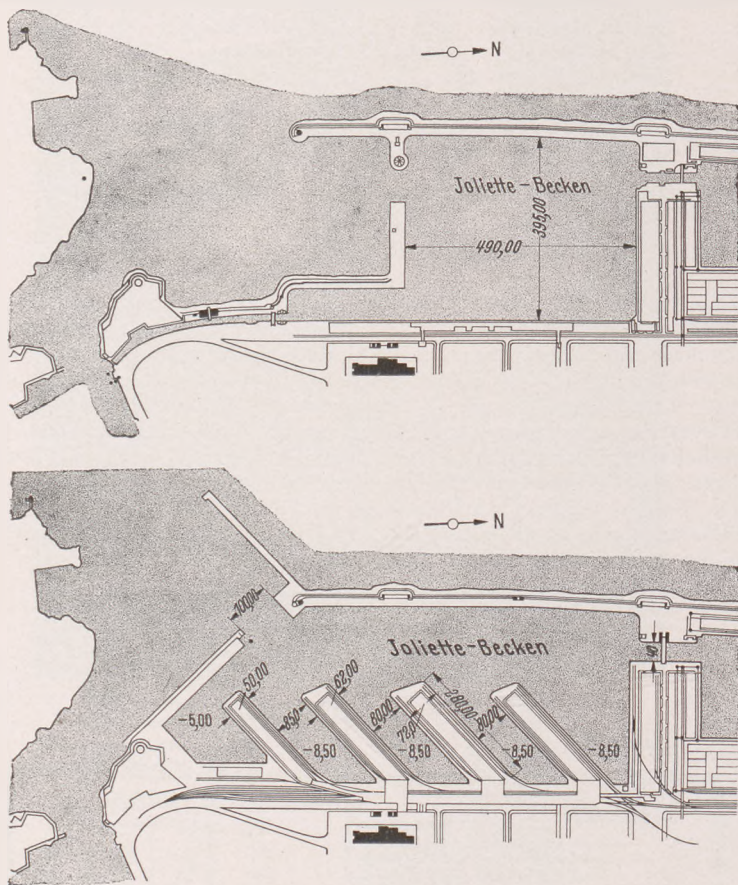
Joliettebecken in Marseille vor und nach dem Umbau.
